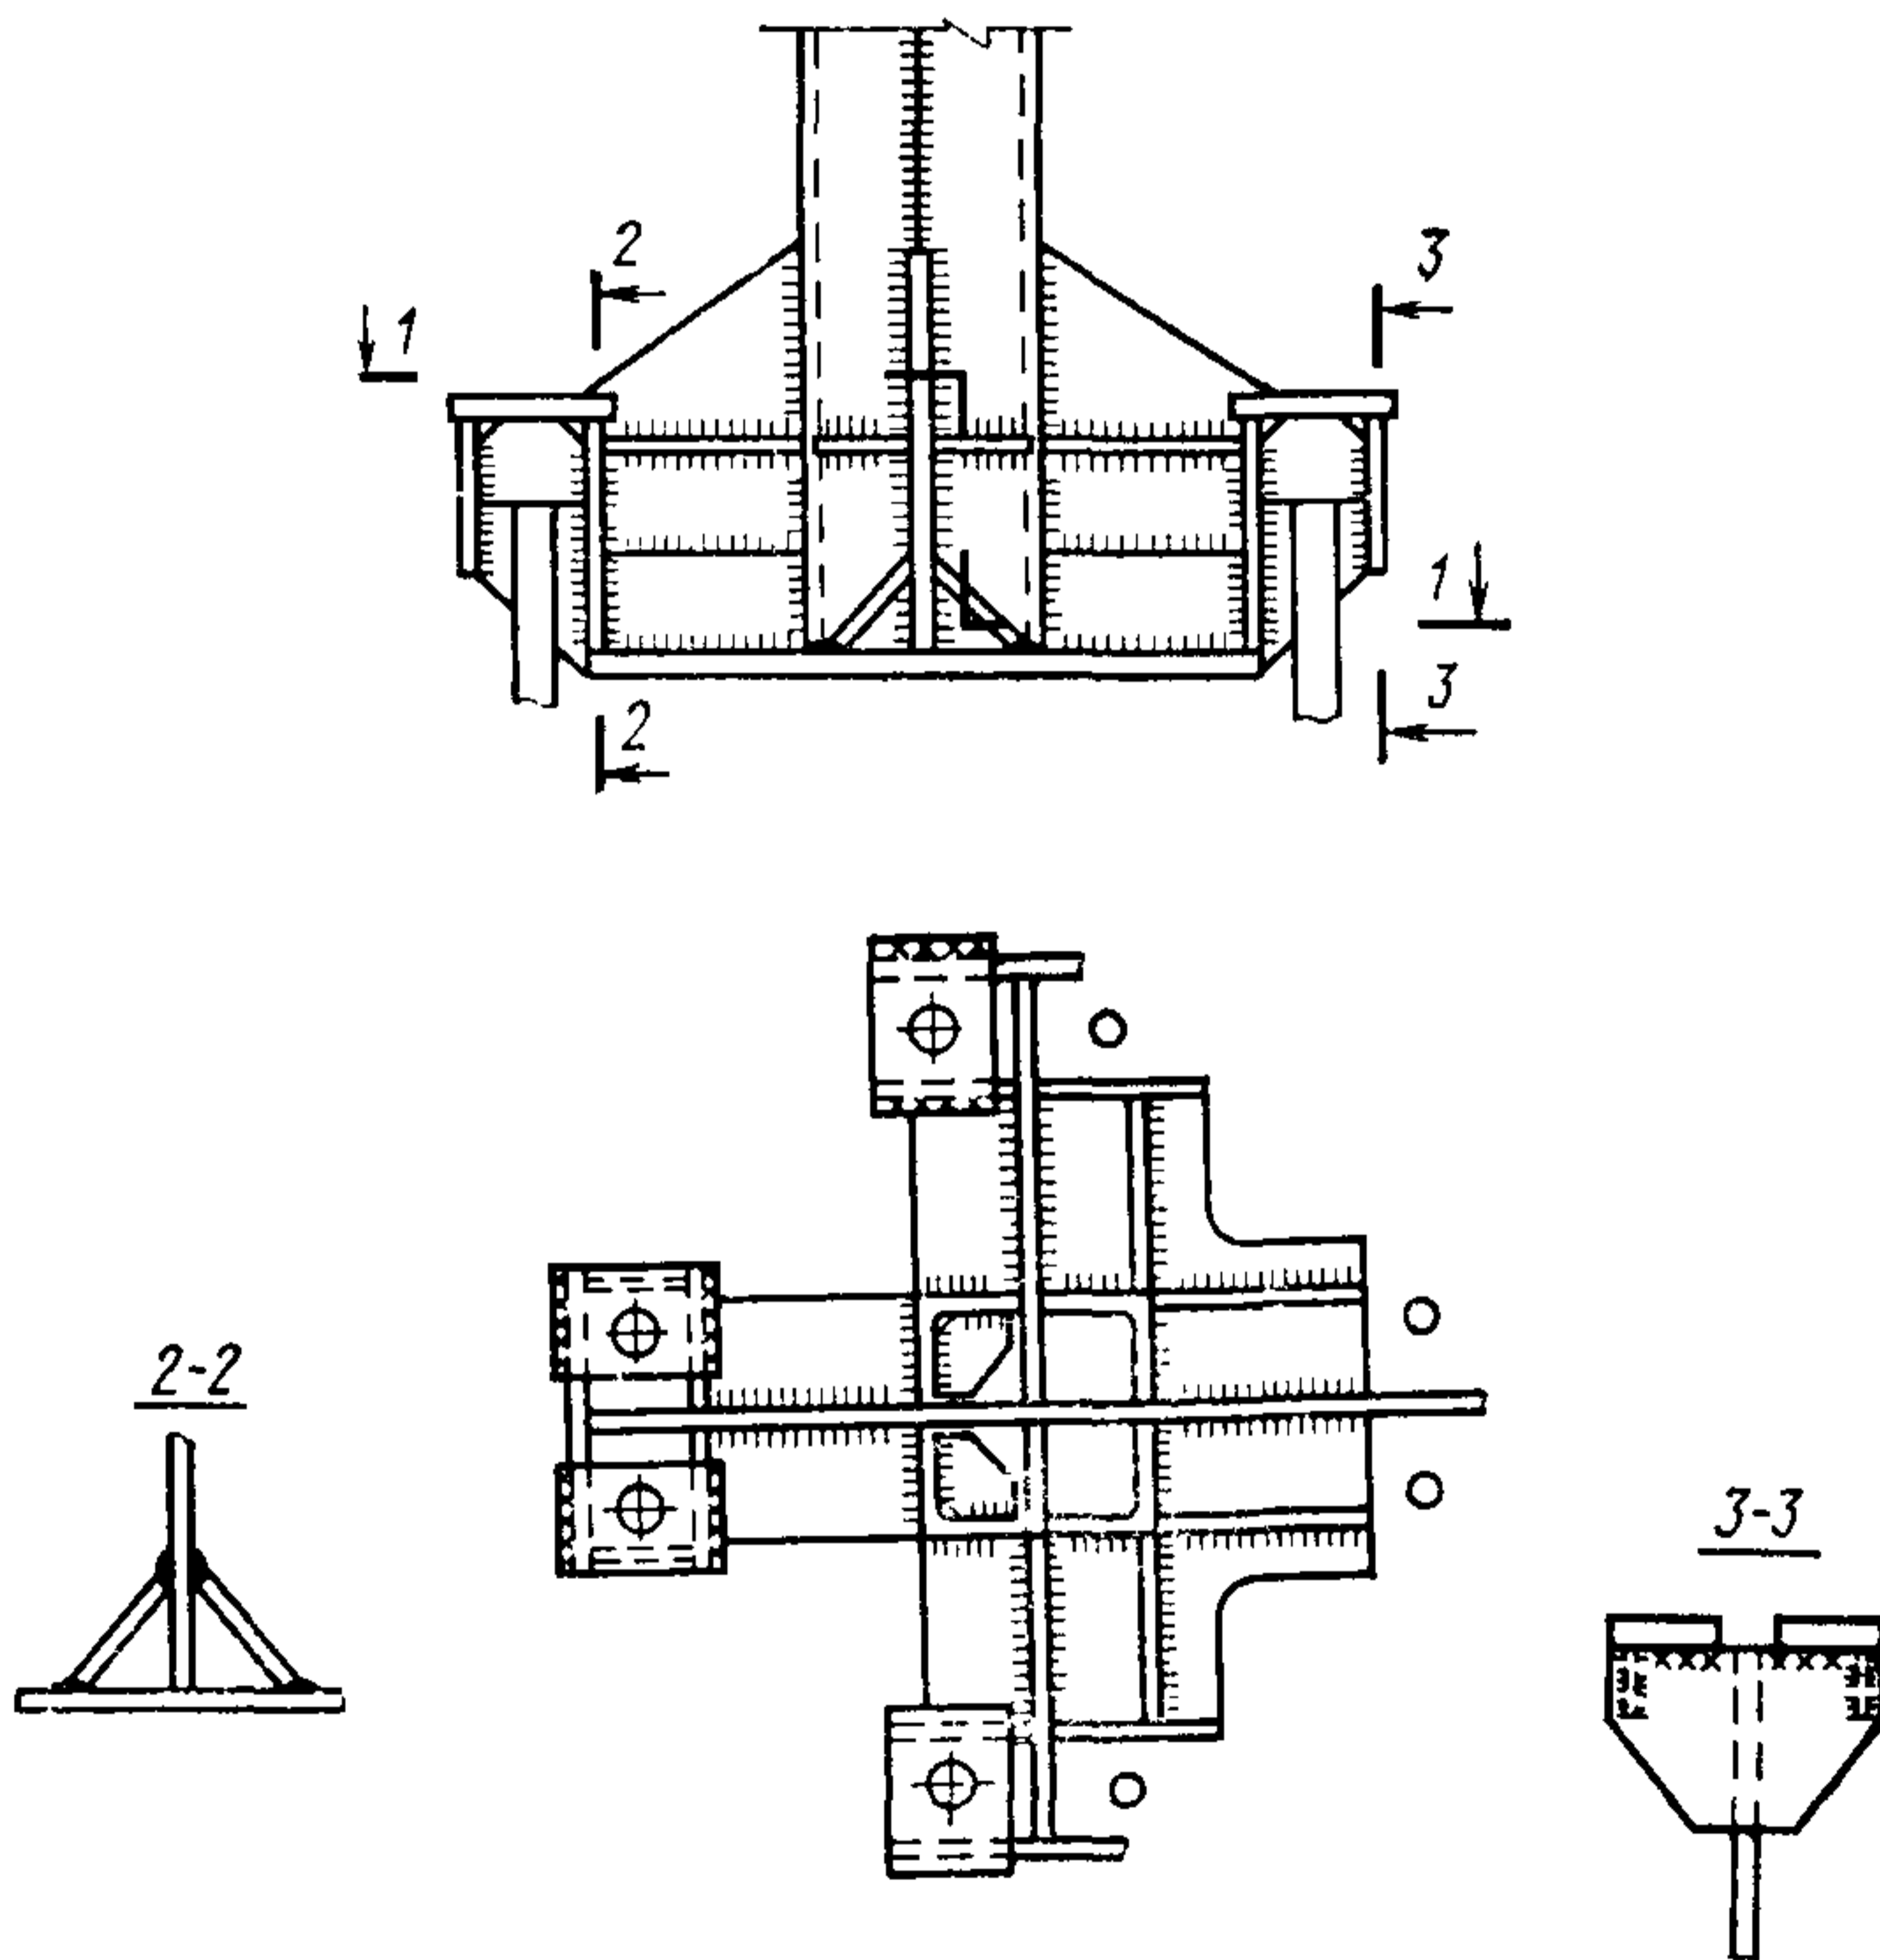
Узел опирания колонны с развитым башмаком на фундамент многоэтажного здания
